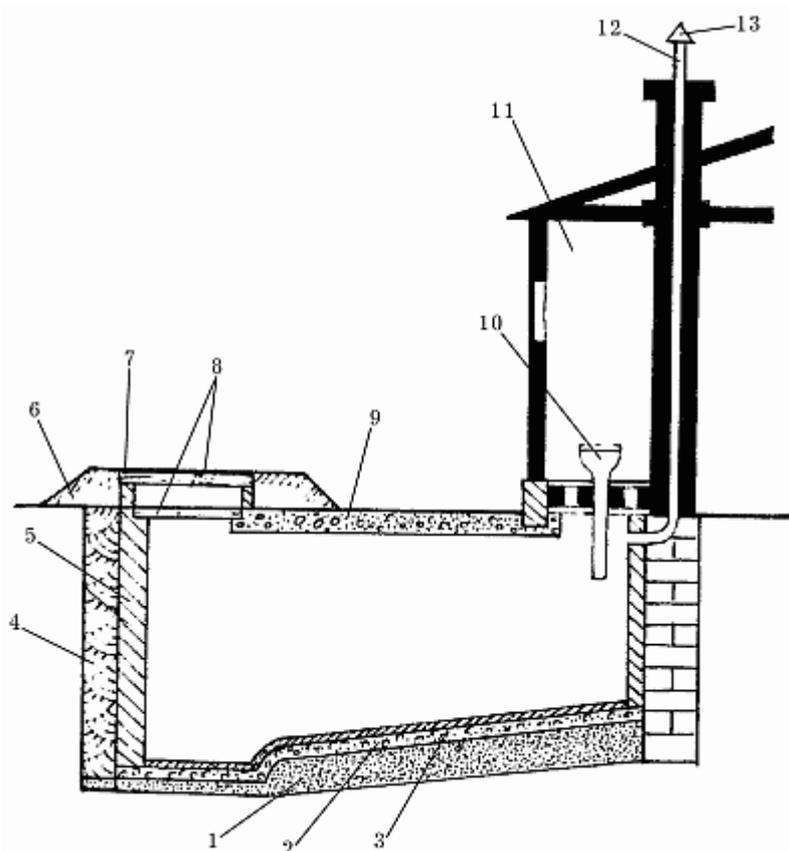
Люфт-клозет: 1 – песчаная подготовка; 2 – бетон; 3 – цементная штукатурка; 4 – глиняный замок; 5 – кирпичная кладка; 6 – насыпной грунт; 7 – рулонная гидроизоляция; 8 – двойная крышка с утеплителем; 9 – железобетонное перекрытие; 10 – приемная воронка; 11 – помещение туалета; 12 – люфт-канал; 13 – дефлектор.
